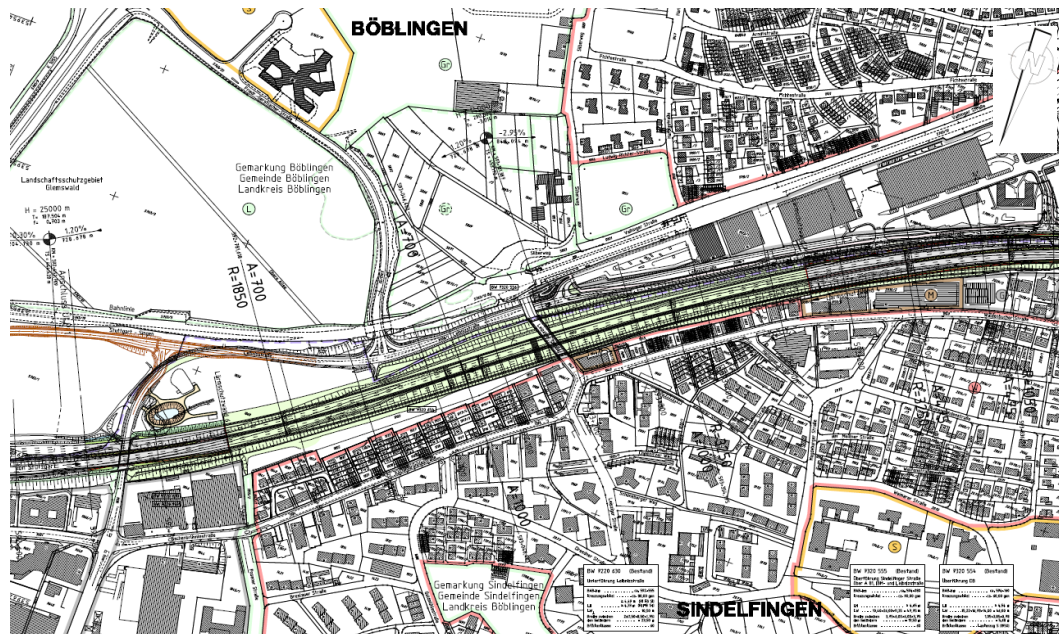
Übersichtslageplan der Überdeckelung Böblingen-Sindelfingen [2]
